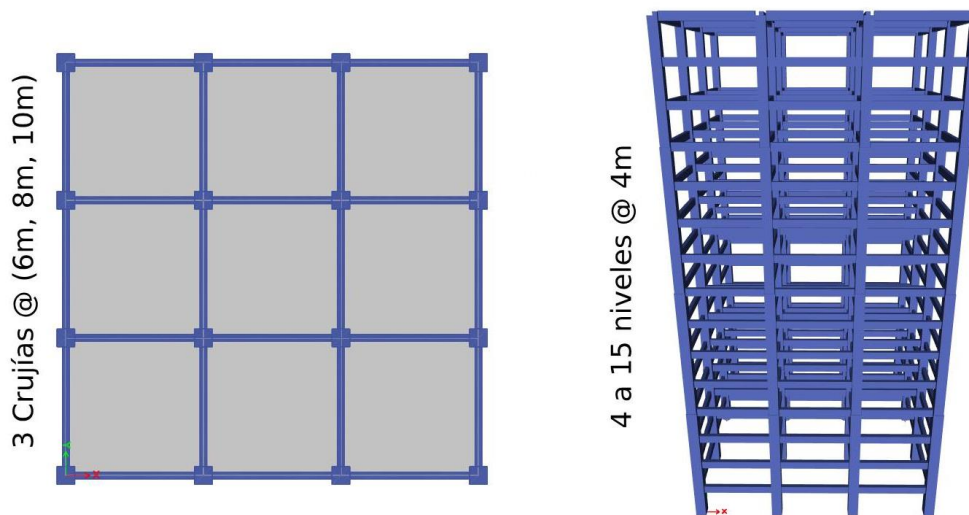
Vista en planta y elevación de los edificios de concreto reforzado (figura tomada de Computers and Structures, Inc 2018, ETABS V18).
